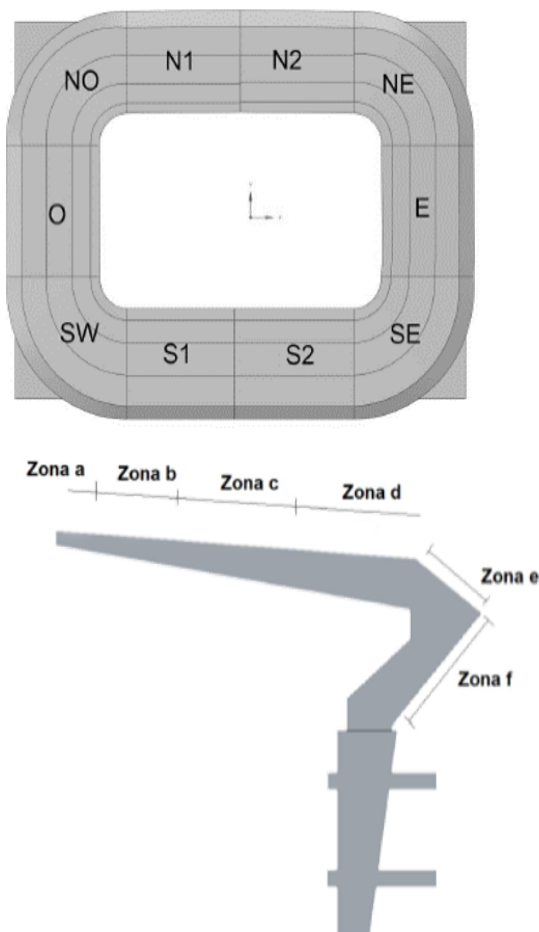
Identificación de discretización de zonas de cubierta en planta y sección
